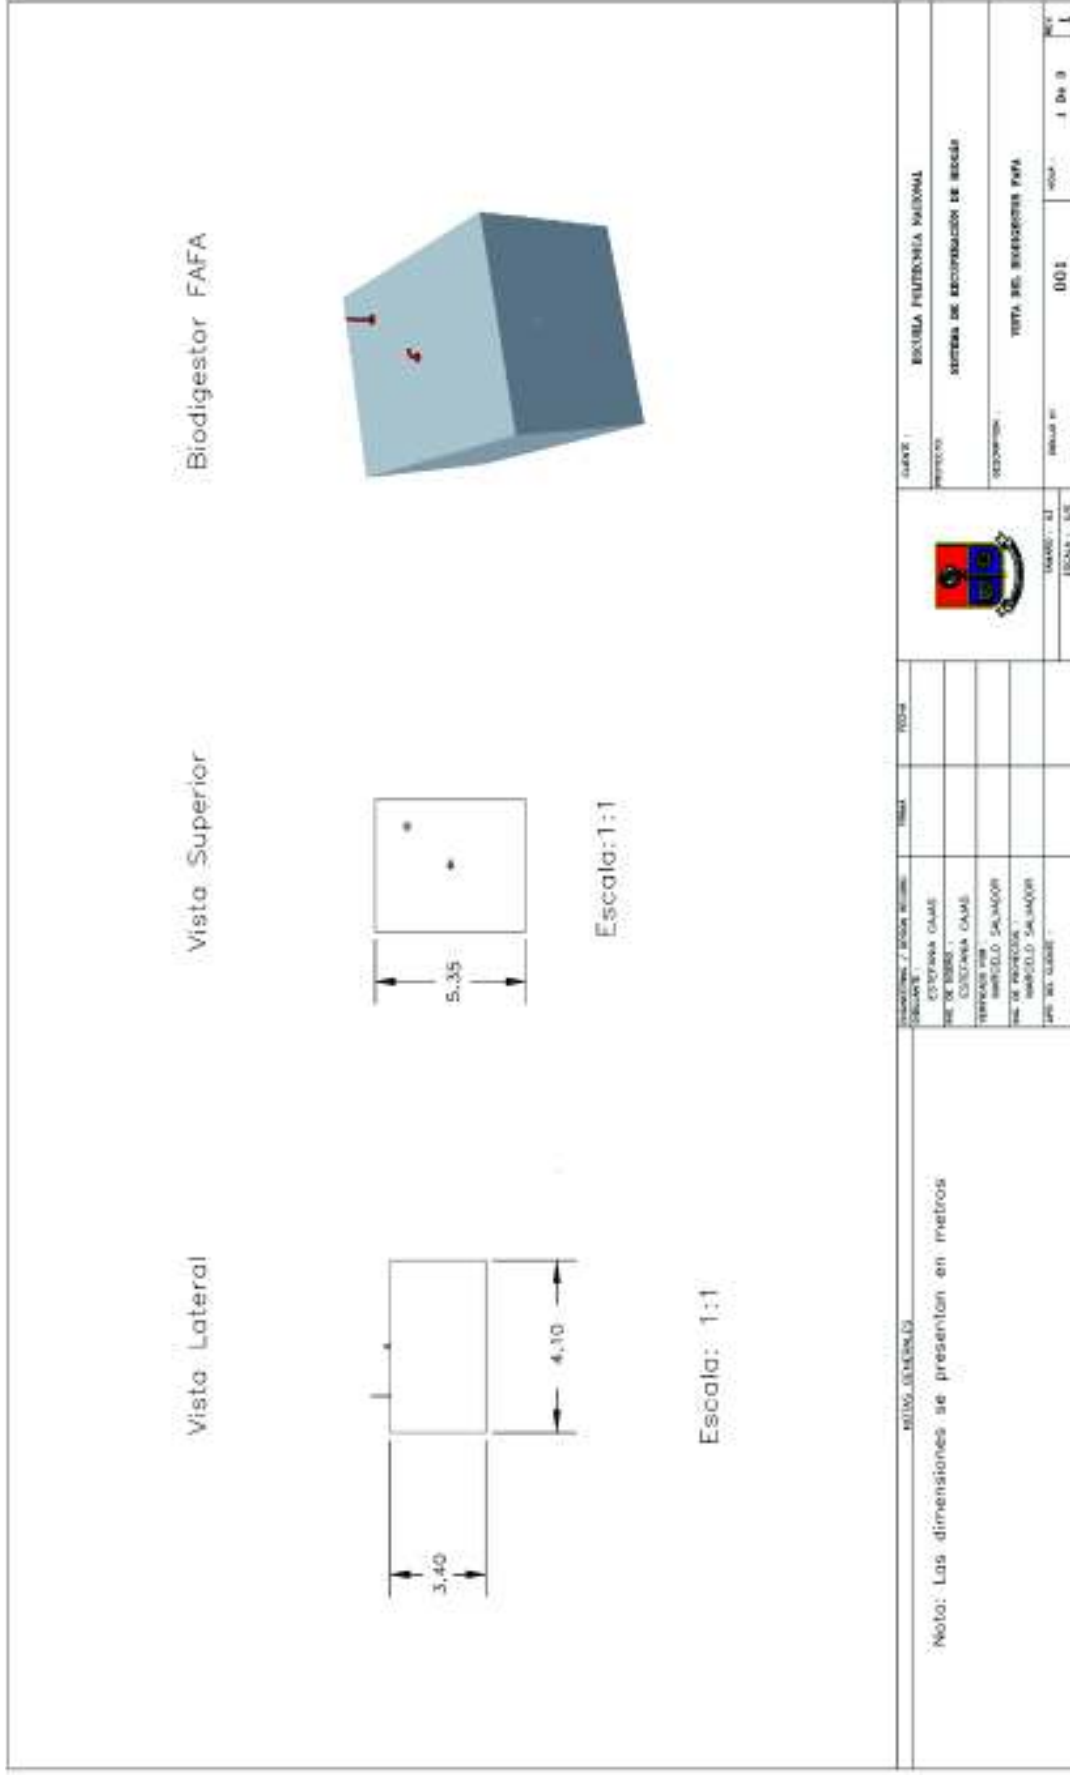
Plano de elevación del biodigester FAFA (R-101)
